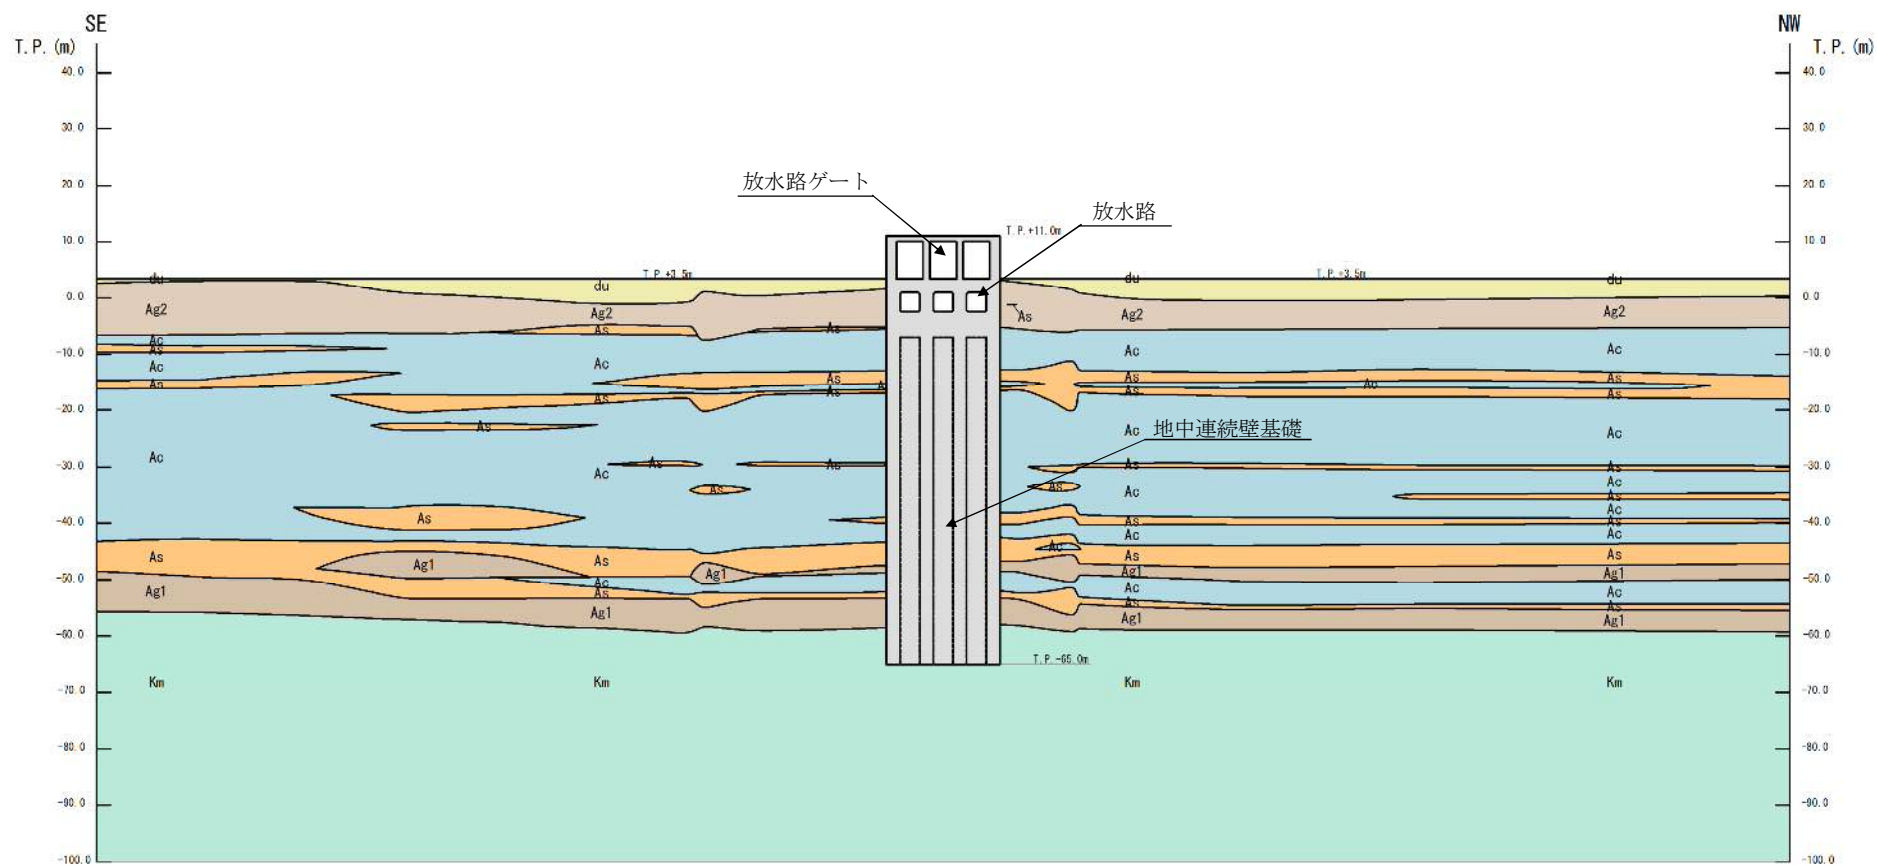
(3) 鉄筋コンクリート防潮壁（放水路エリア）の評価対象断面図（防潮壁縦断方向：③-③断面，ゲート部）
